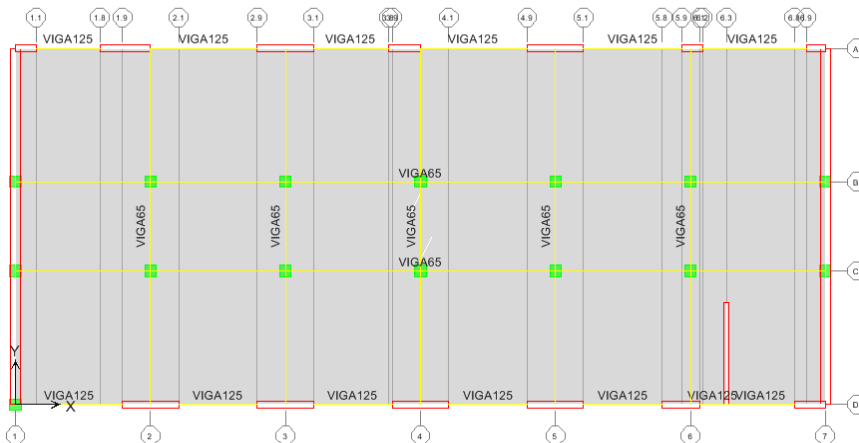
f Distribución en planta de vigas, columnas, placas y losas utilizado en el análisis para un piso típico
